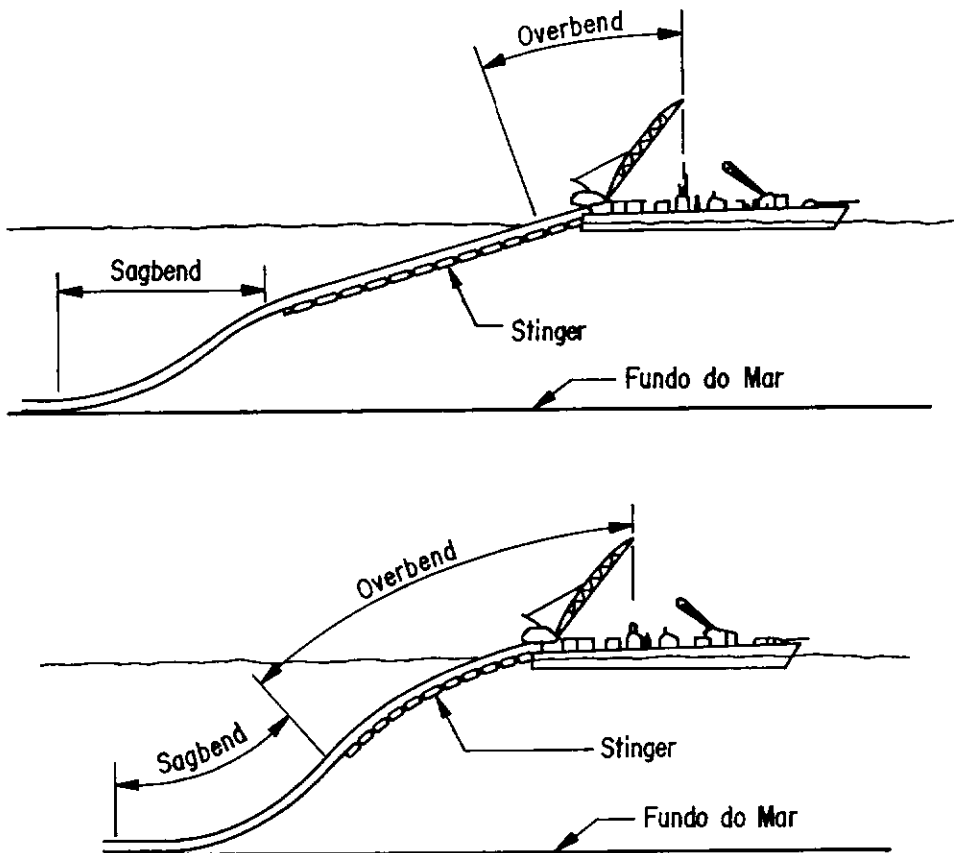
Lançamento com barcaça - stingers reto e articulado.
